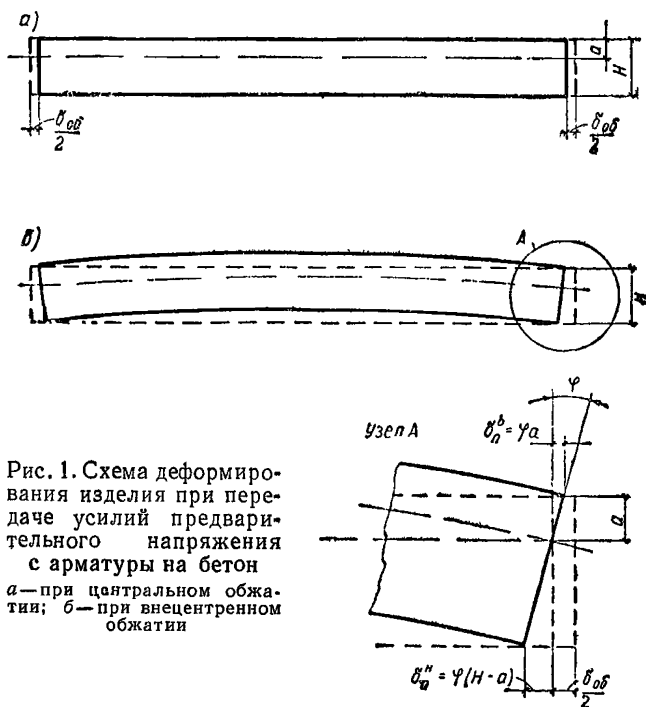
Схема деформирования изделия при передаче усилий предварительного напряжения с арматуры на бетон
